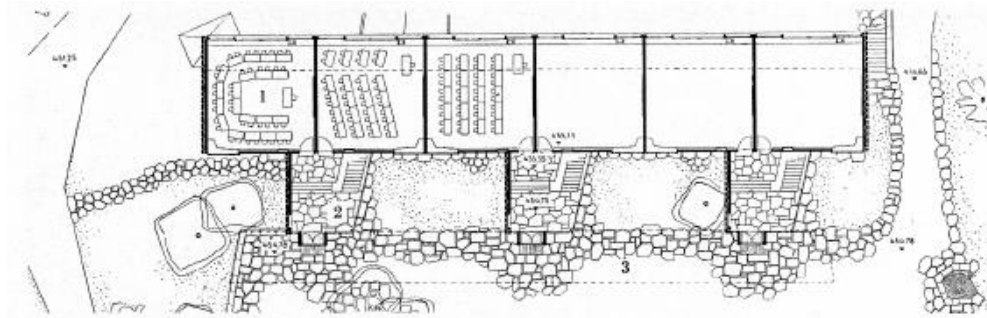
Primera planta del Matt Primary School. (Roth 1950, 126)
